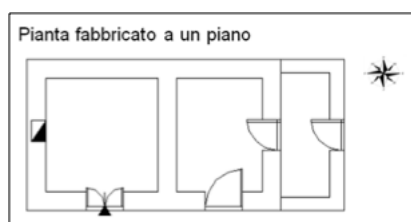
Pianta di fabbricati in ciucioli di Senise a un piano.
